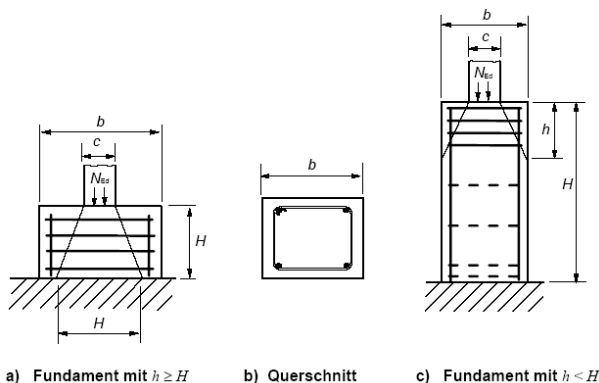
Spaltbewehrung bei Einzelfundamenten auf Fels
